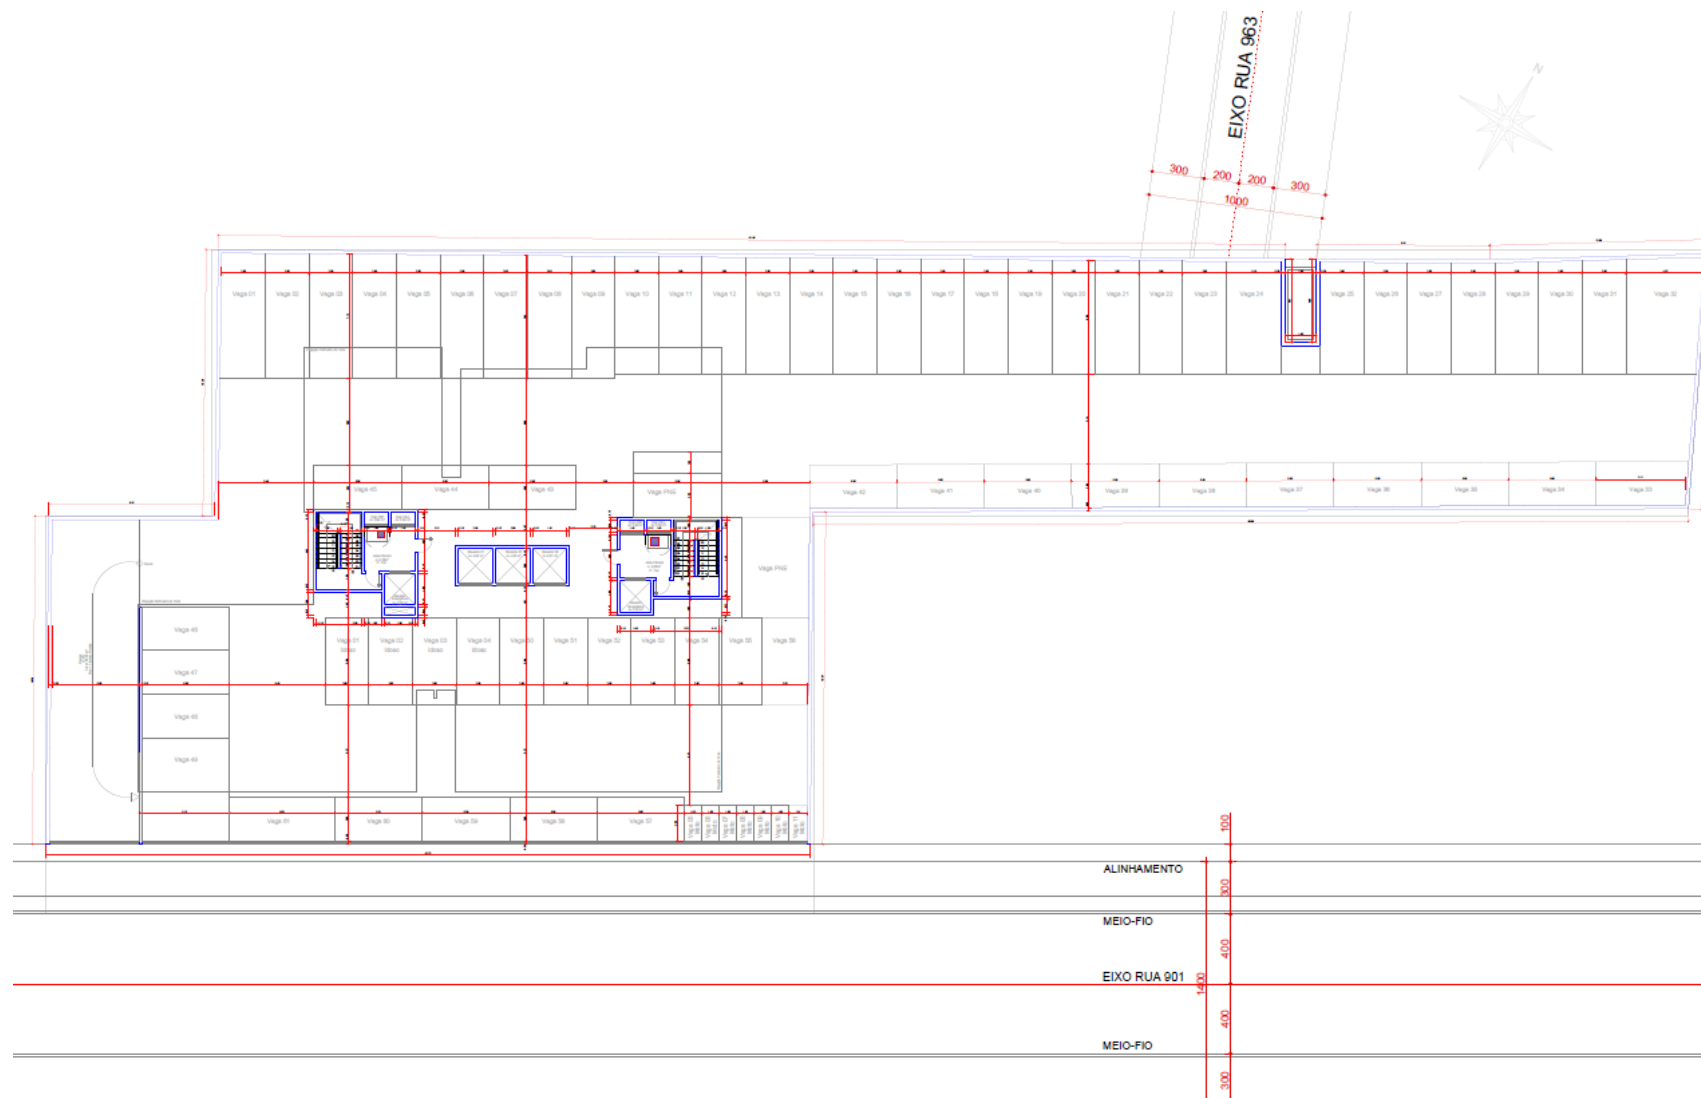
Planta Baixa - 5º Pavimento Garagem - Área: 2.063,10m².
